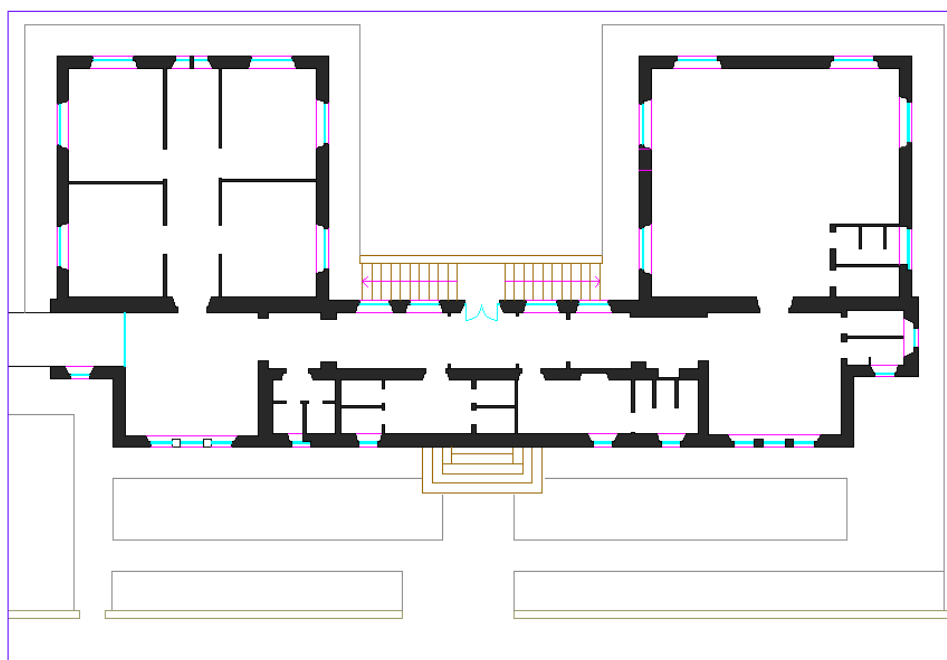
Planimetria stato attuale – PIANO SEMINTERRATO
